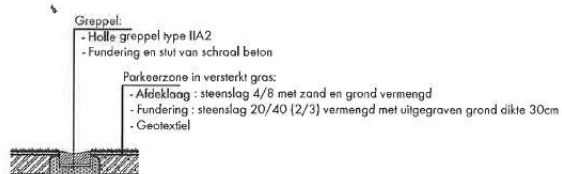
Plan van de ontworpen toestand, detail uit bijlage 1 (bron: Gemeente Kluisbergen)
